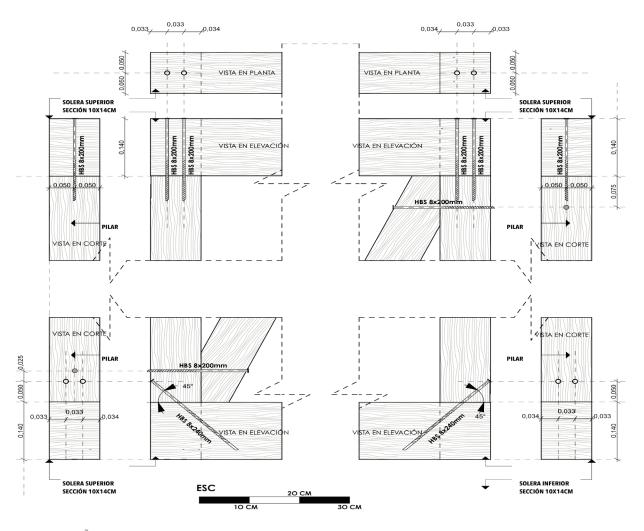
DISEÑO DE UNIONES PARA PANEL DE ENSAYO REALIZADAS CON TORNILLO, FUENTE: AUTOR
